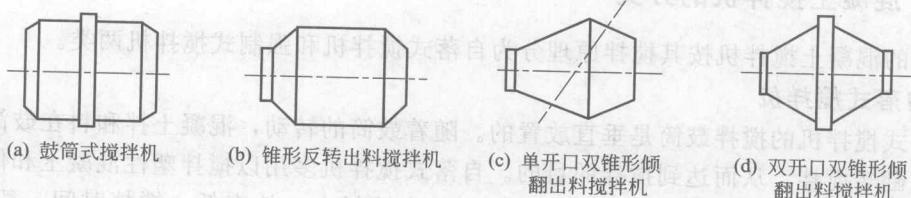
自落式混凝土搅拌机搅拌筒的几种形式
